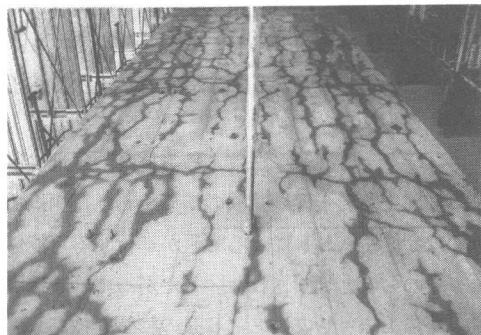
橋脚柱部のASRによるひび割れの発生状況
